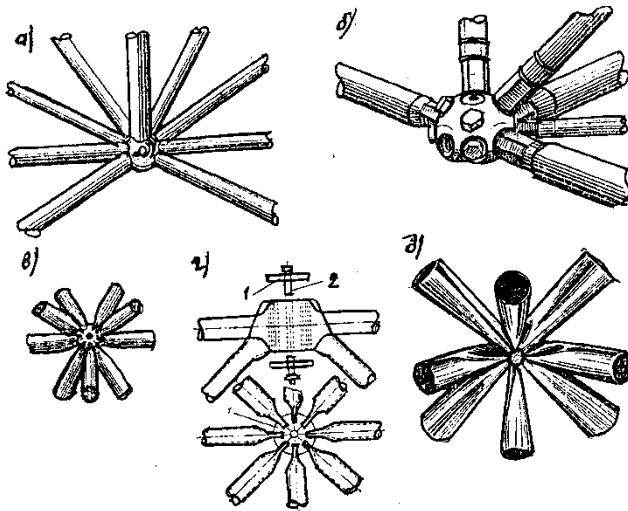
Вузли сполучення структур: а – кулькова вставка; б – на гвинтах; в, г – з циліндричним сердечником з прорізами, який стягнутий болтом 1 з шайбами 2; д – зварний вузол сплюснутих кінців
